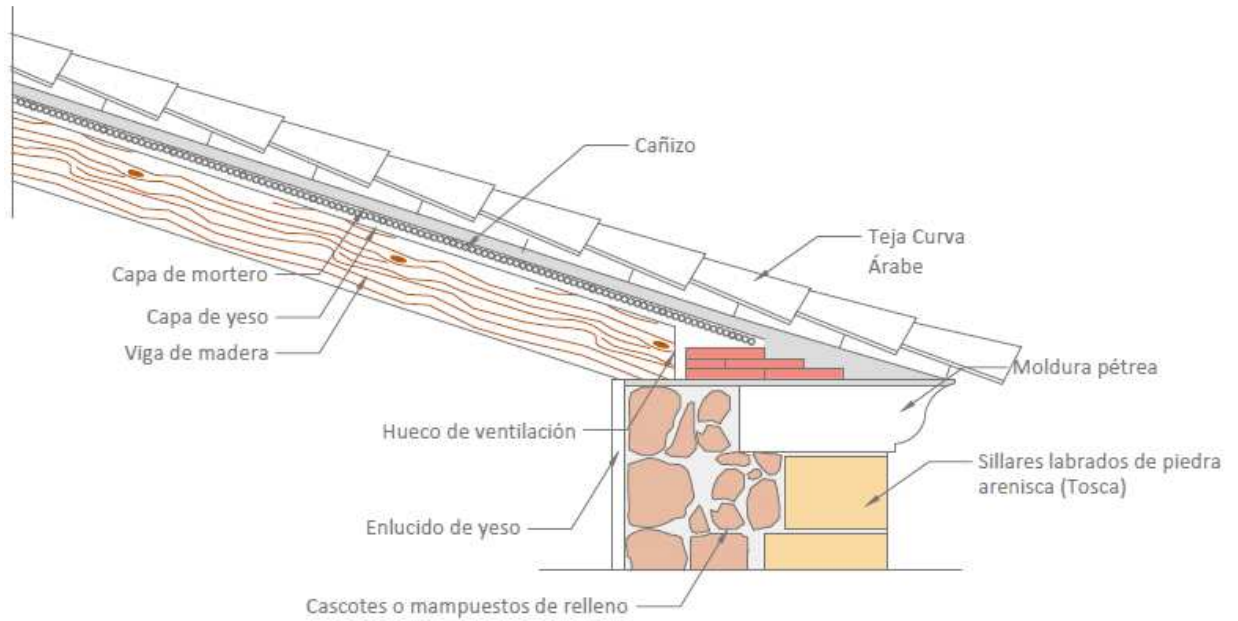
Forjado inclinado bajo cubierta formado por vigas de madera y entrevigado de cañizo. Elaboración propia
